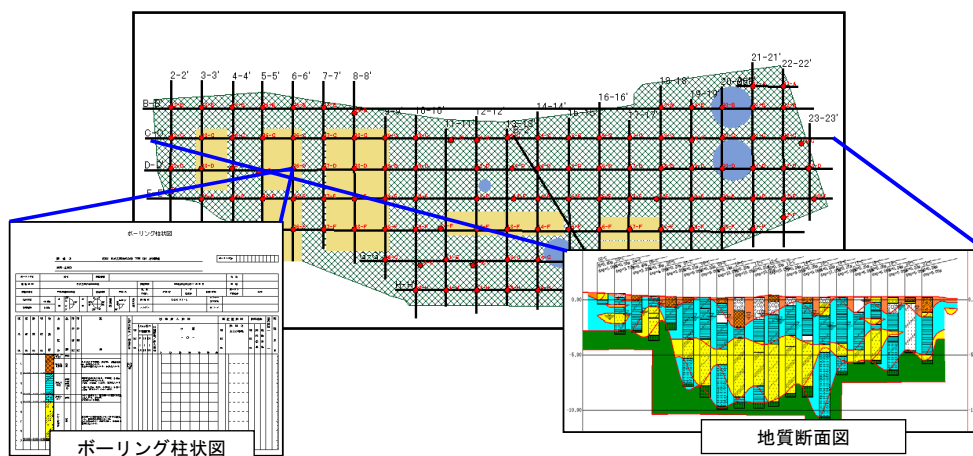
平面図とリンクして柱状図や断面図管理を実施している例
